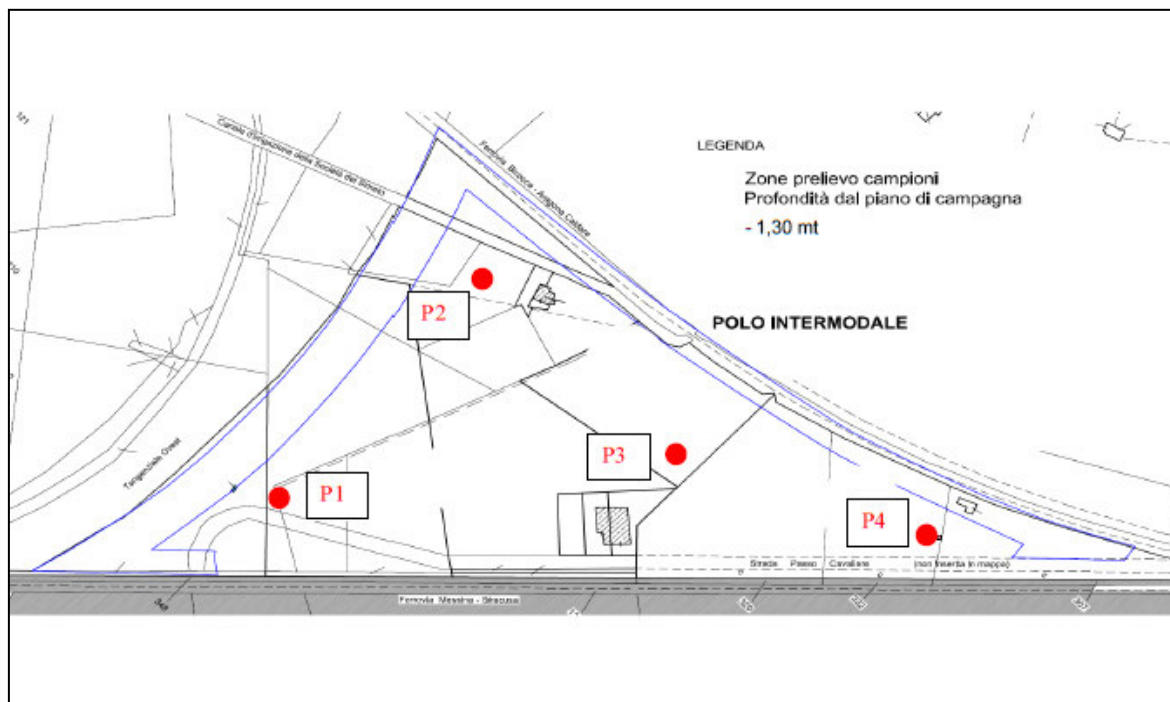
Stralcio planimetria con ubicazione pozzetti d'ispezione
